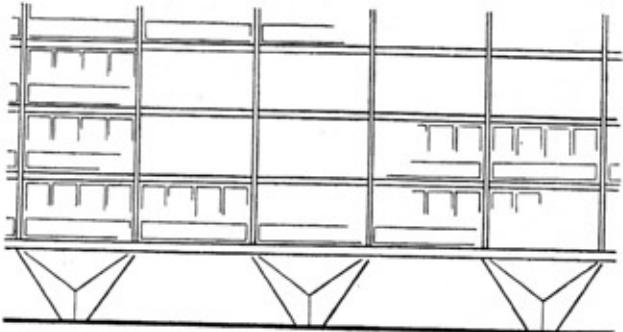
Жилое здание в Берлине. Вилообразные опоры в первом этаже. Арх. Оскар Нимейер
